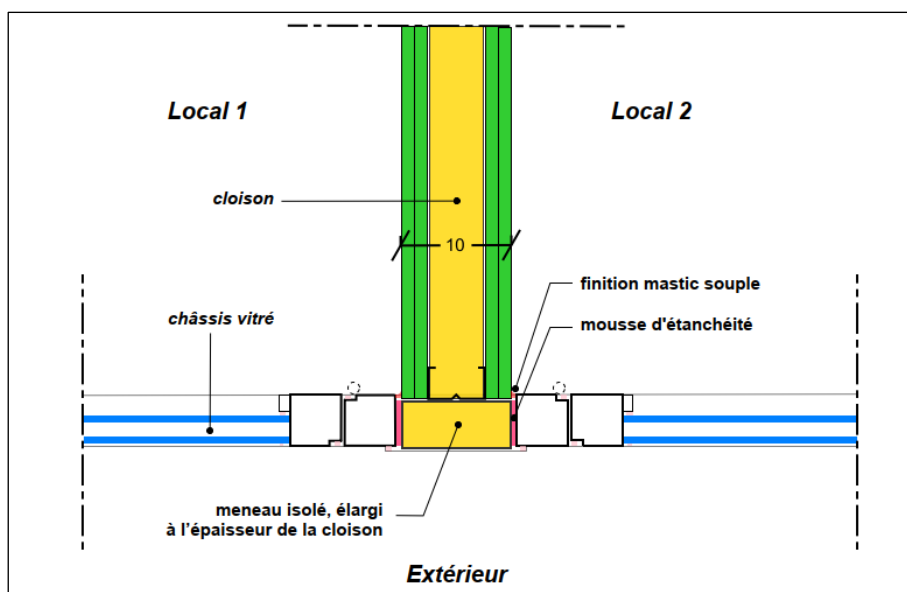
Principe de jonction cloison - façade avec meneau élargi (coupe horizontale)
